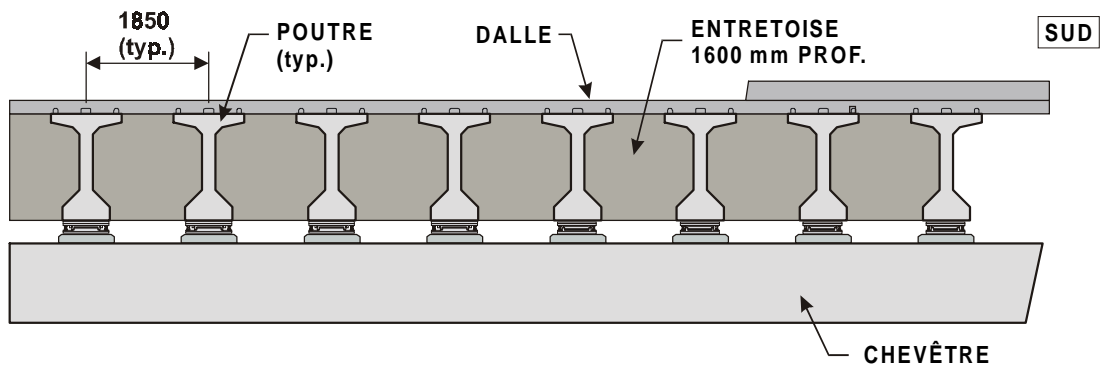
Dimensions nominales des poutres préfabriquées en béton
